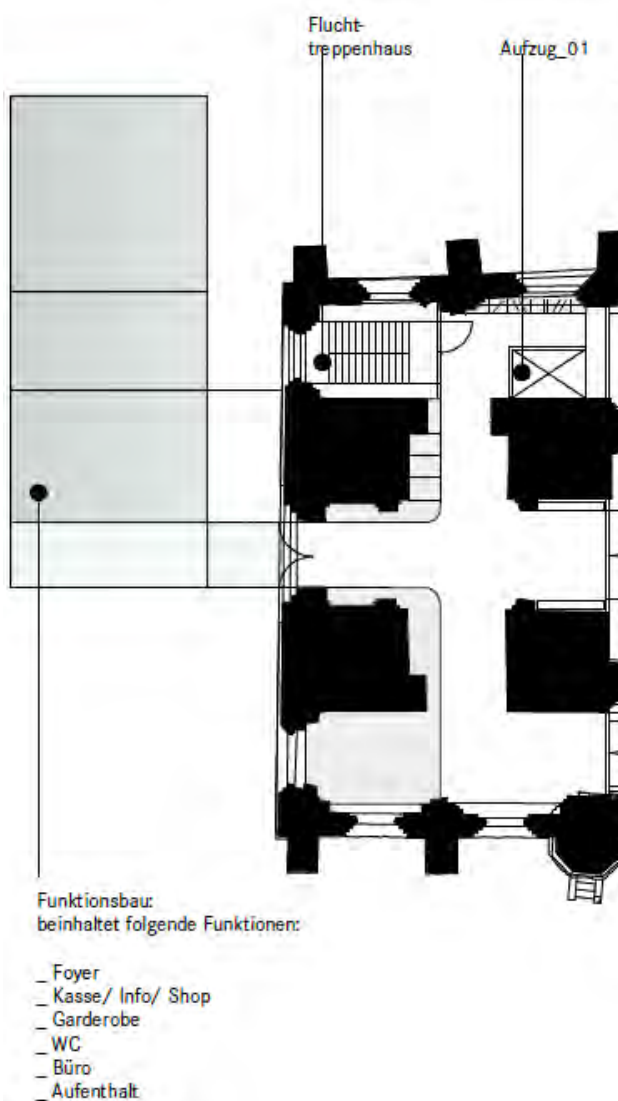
Grundrisse des Empfangsgebäudes mit Foyer
